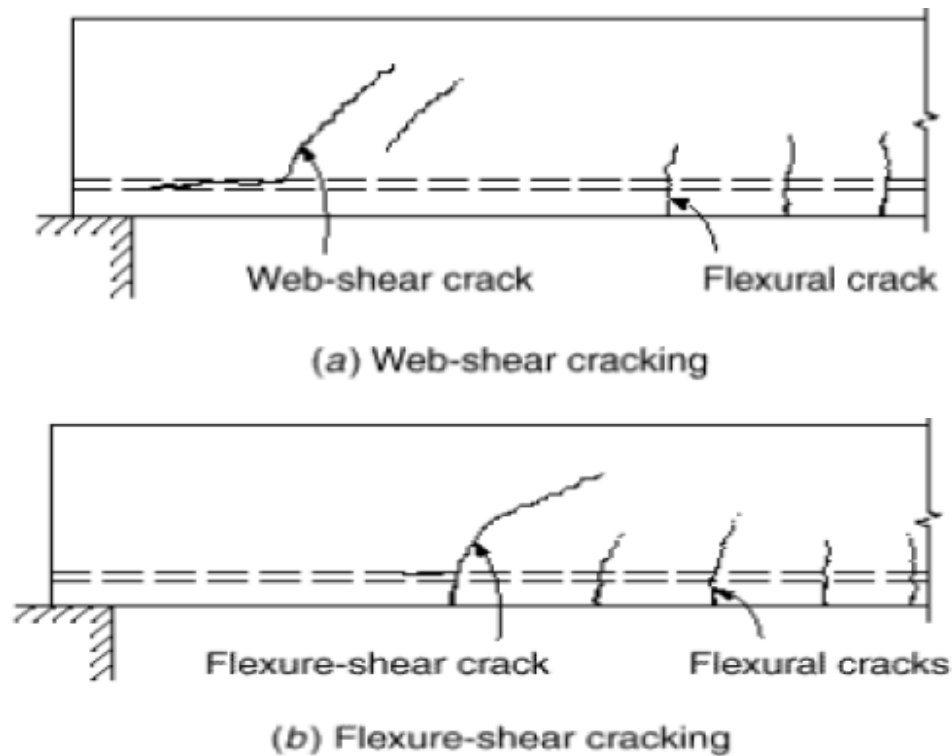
Types de fissures inclinées (a) fissuration de cisaillement d'âme, (b) fissuration de flexion-cisaillement [5].
